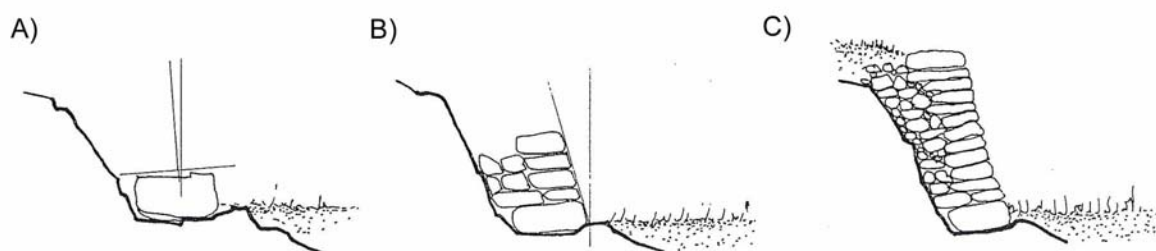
Particolari costruttivi di un muro a secco: A) posa in opera sullo scavo di fondazione della pietra basale della struttura; B) fase di elevazione del muro; C) completamento della muratura con il posizionamento del detrito a tergo e la copertura del predetto materiale drenante con terreno compattato (da BRANCUCCI et al., 2000) -
